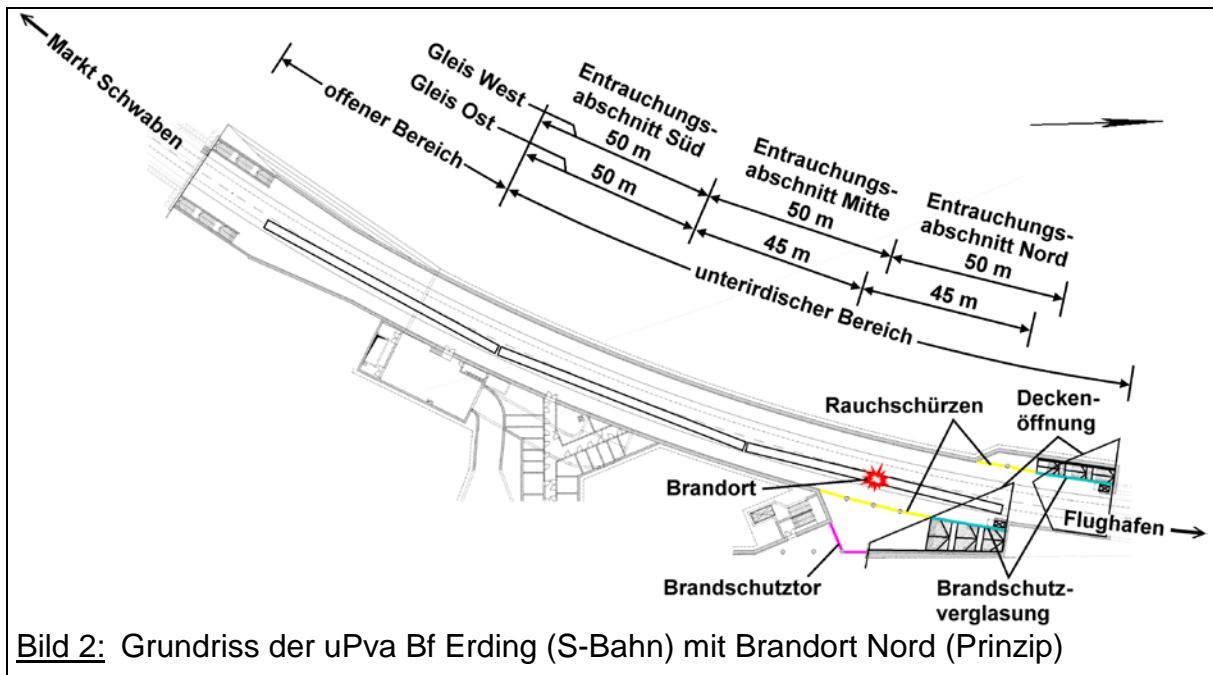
Grundriss der uPva Bf Erding (S-Bahn) mit Brandort Nord (Prinzip)
